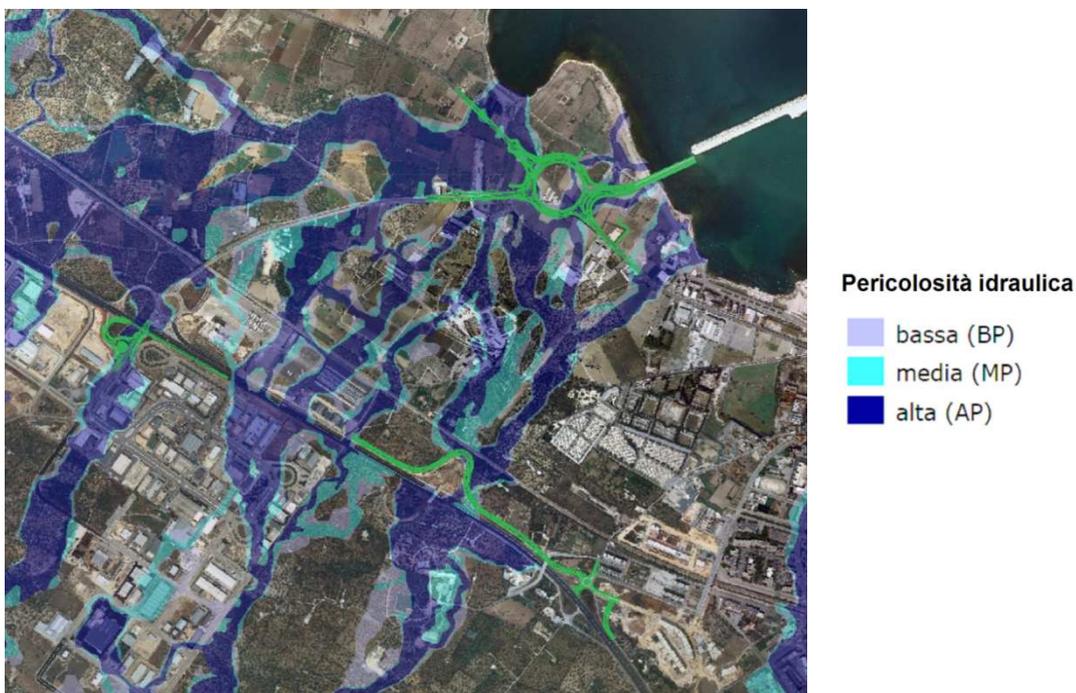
Stralcio planimetria di sovrapposizione PAI (Pericolosità idraulica)
